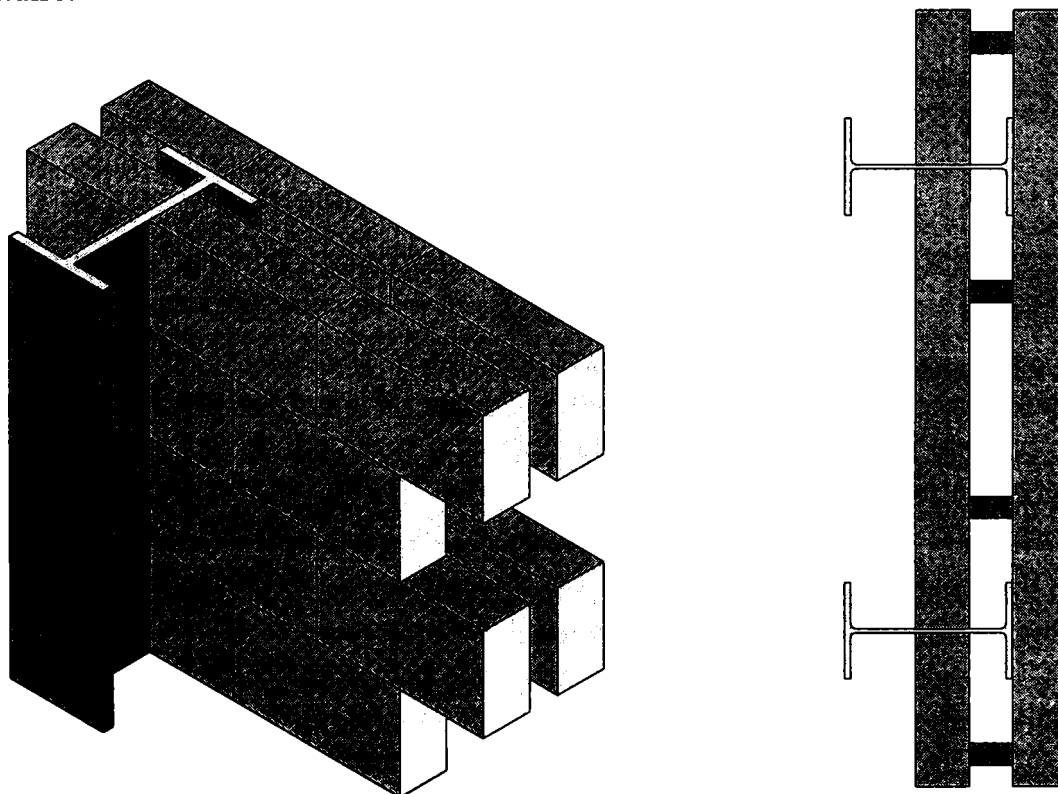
Sistem de înglobare a stâlpilor metalici în perete de zidărie sau beton.
